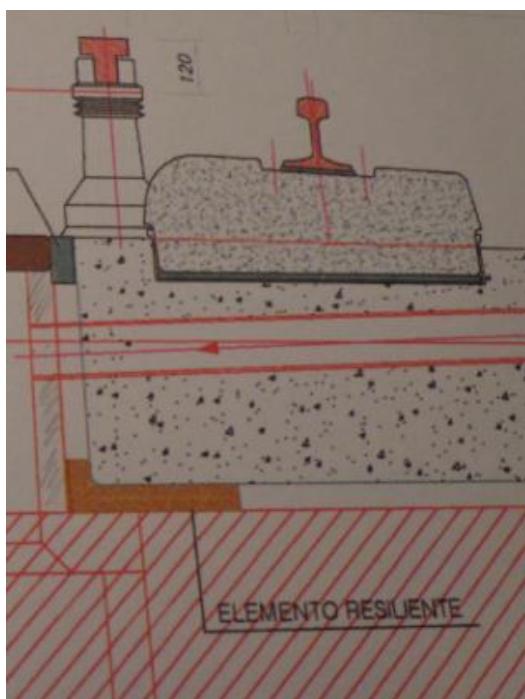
Pormenor de aplicação da 4ª e 5ª solução [16]
